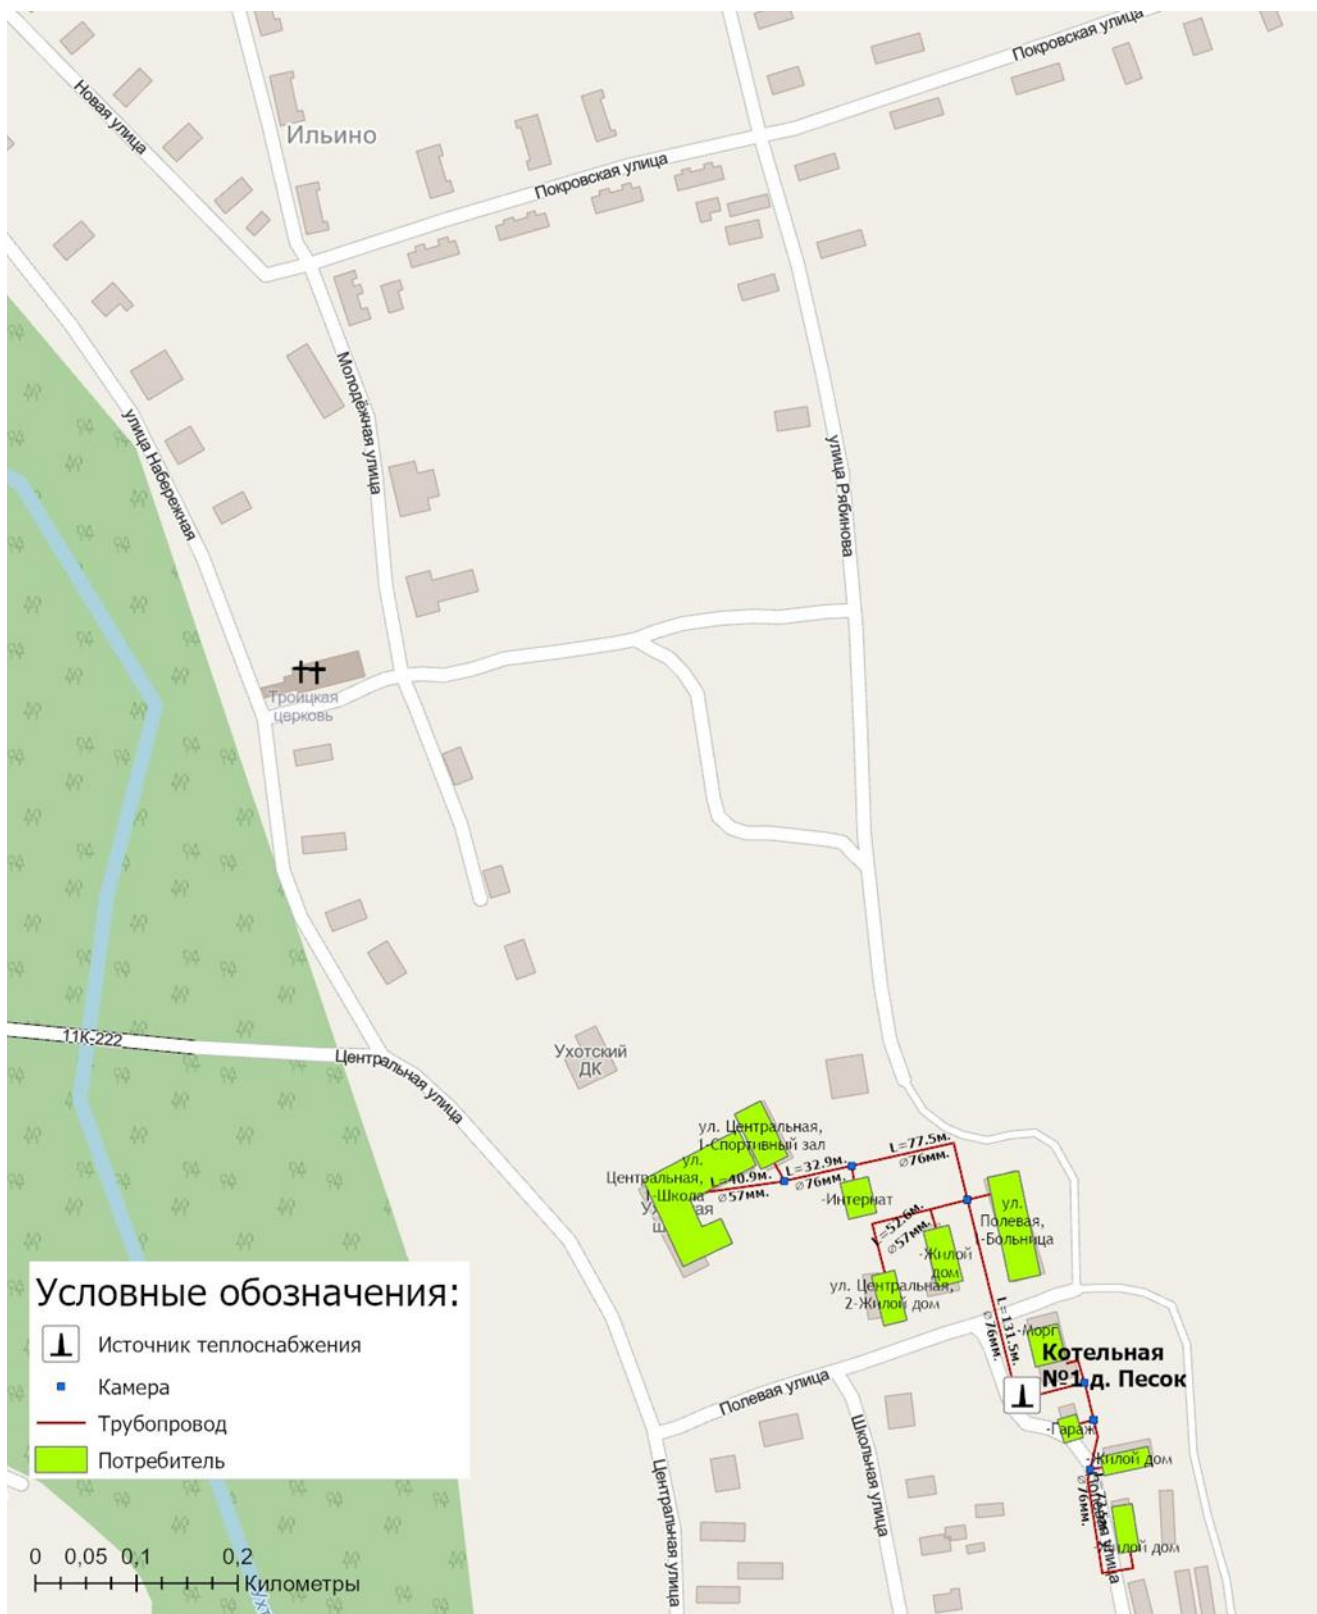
Схема тепловых сетей котельная № 1 д. Песок
